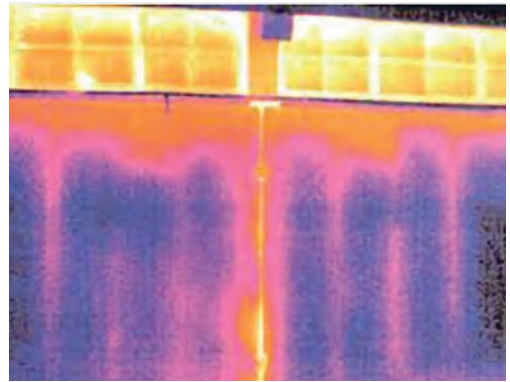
Тепловизионный снимок наружной стены из трехслойных панелей
